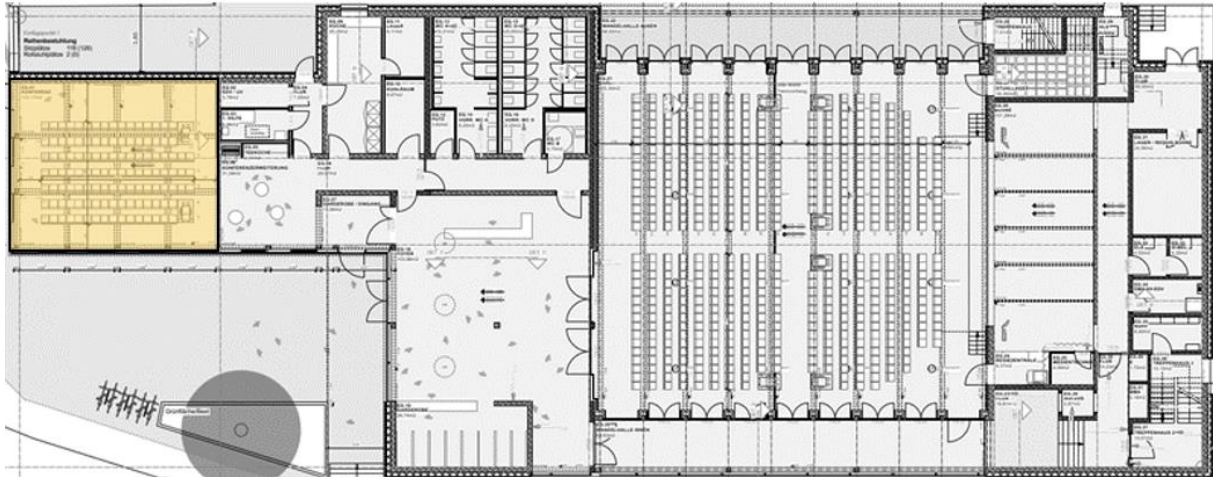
Grundriss Erdgeschoss mit dem untersuchten Raum.
